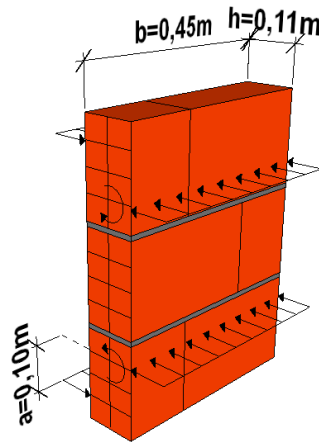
Esquema de carregamento do provete de alvenaria quando sujeito à flexão segundo um plano de rotura paralelo às juntas de assentamento.
